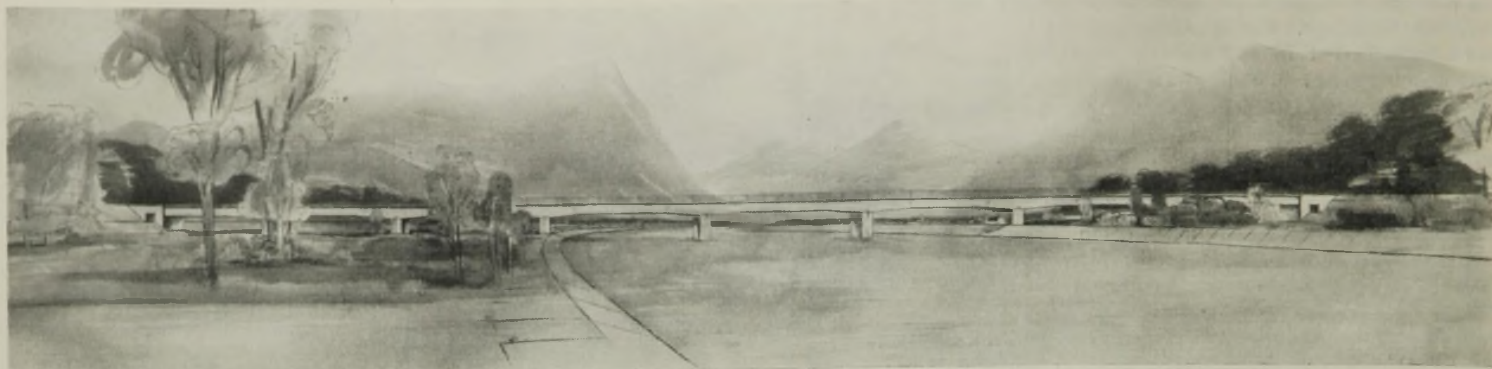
Eisenbetonbalkenbrücke mit Vouten über den Pfeilern. Der zur Ausführung gewählte Entwurf der Firma Leonhard Moll, München.
